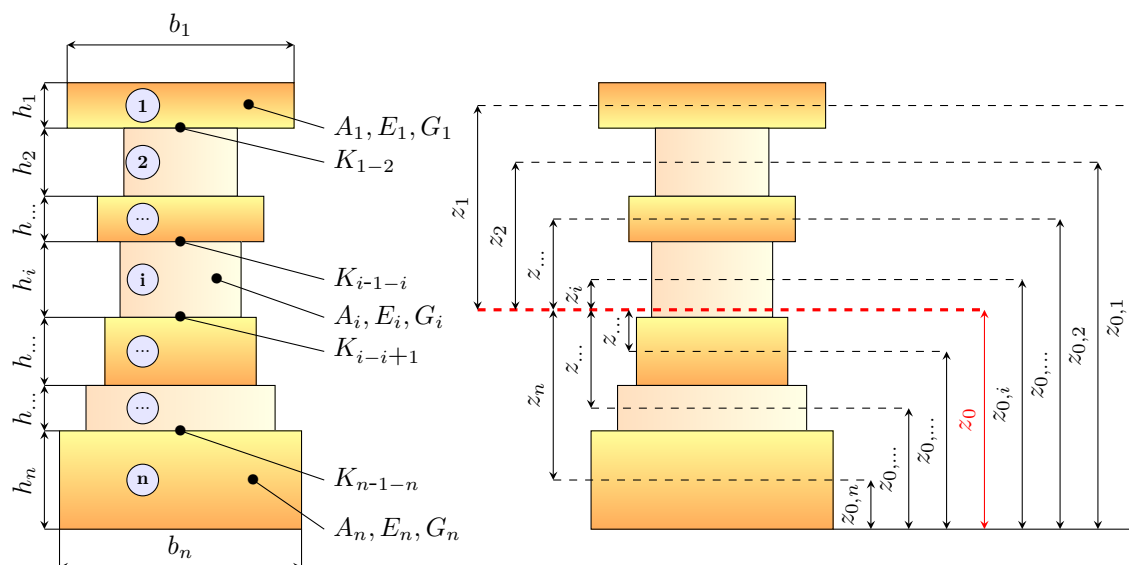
Section et propriétés mécaniques de la poutre reconstituée
